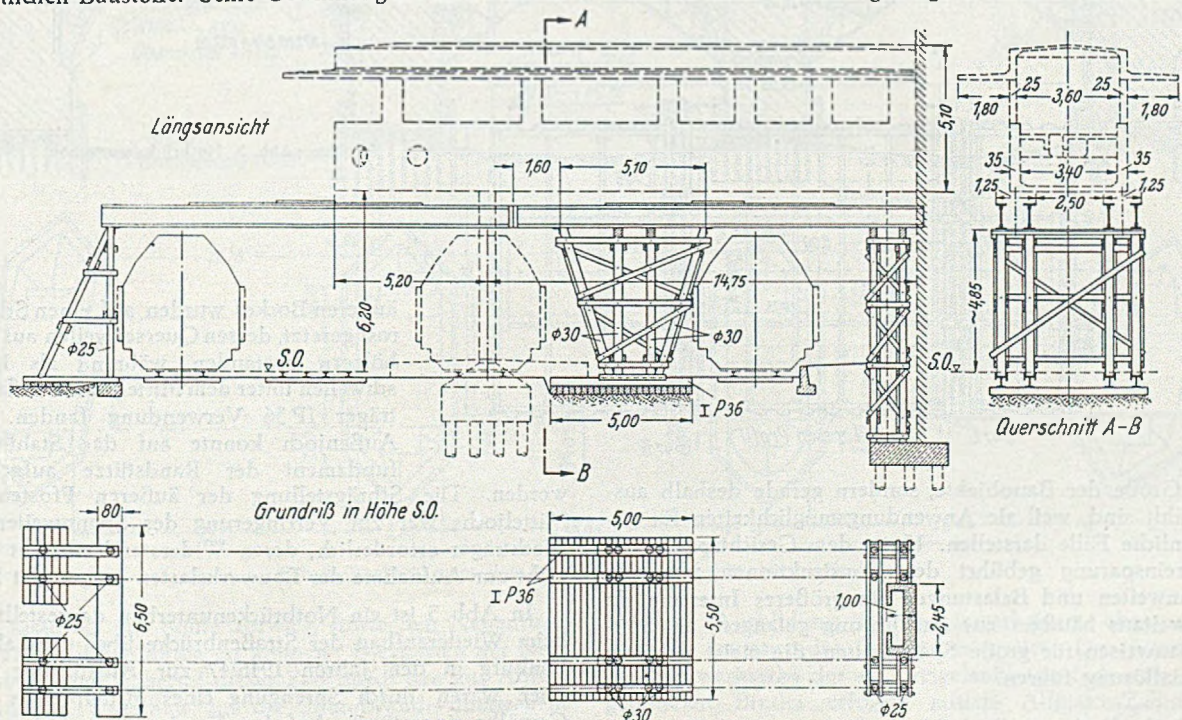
Untergerüst für die Stellwerkeinrüstung.
